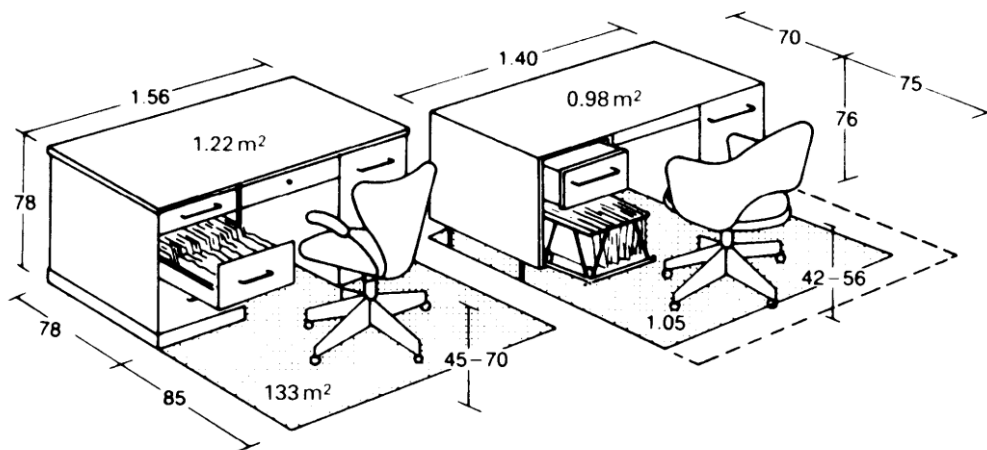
Standar Ukuran Denah Ruang Pengelola individu
